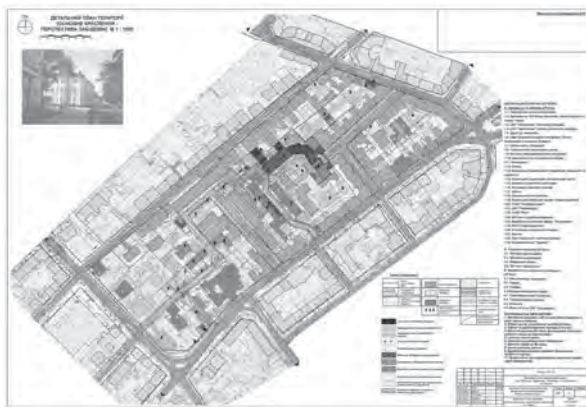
Детальний план території. Головне креслення (перспектива забудови)
